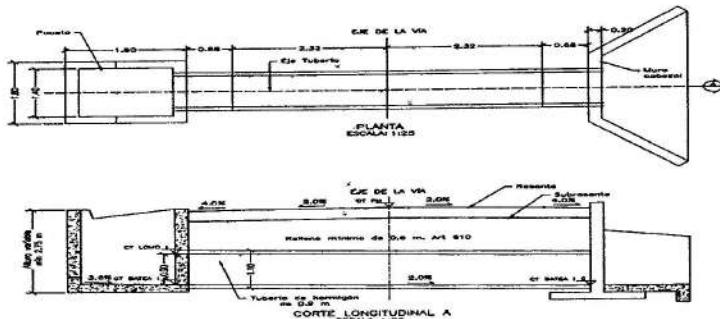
Geometría Alcantarilla 36" y vista en planta Fuente: Municipio de la Jagua de Ibirico
